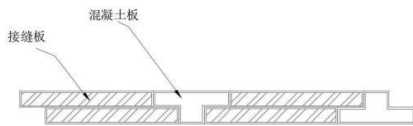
为错位接缝的水库大坝防渗加固施工方法的混凝土板与接缝板拼接结构示意图
